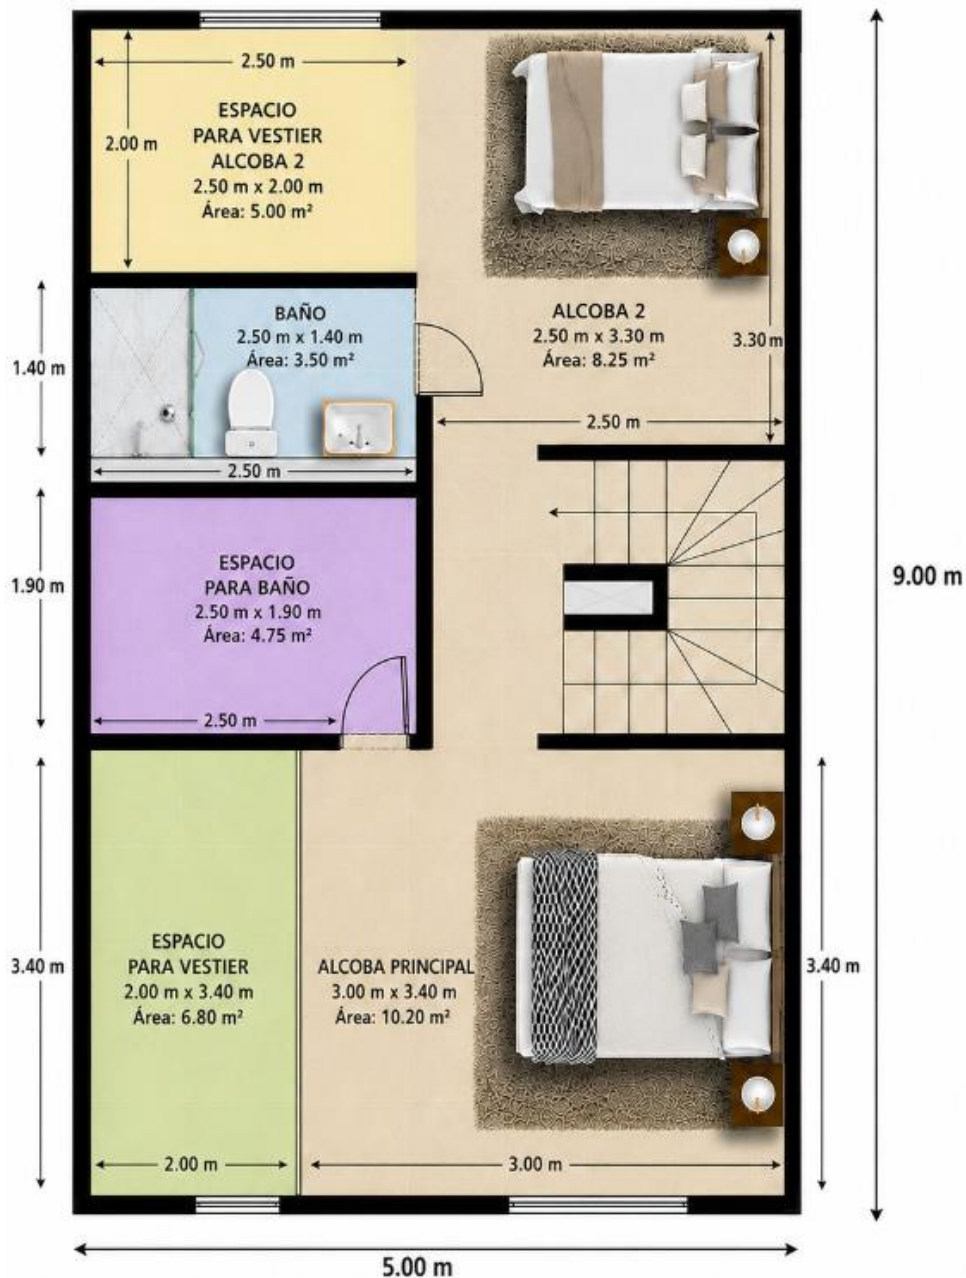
Planta arquitectónica del segundo piso. Fuente: Propia.
